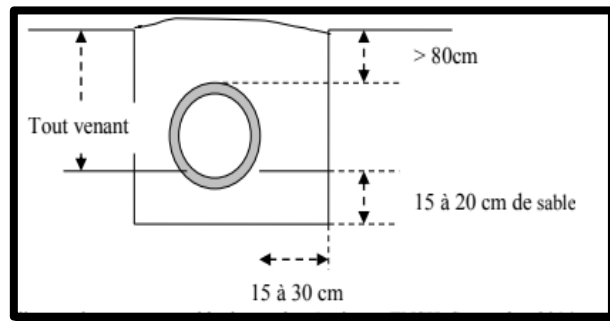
Pose de conduite en tranchée dans un terrain ordinaire (source : SALAH B., 2014)
